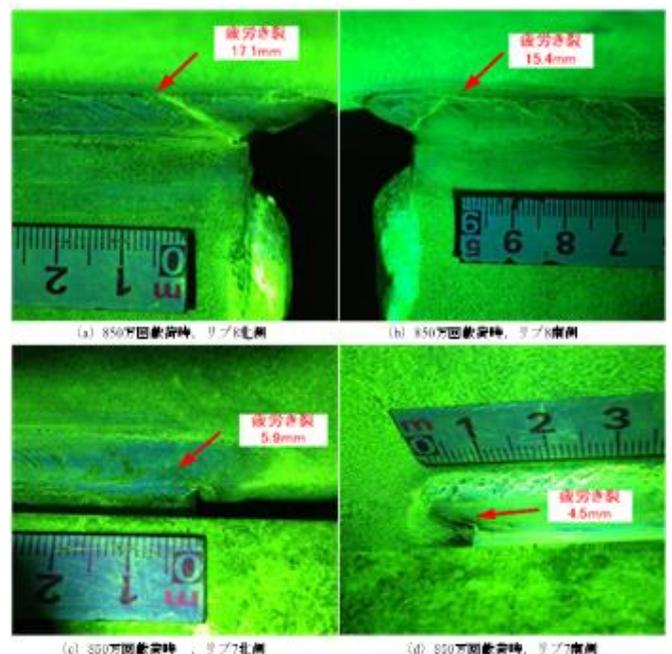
試験終了時のき裂進展状況 (リブ7, 8)
